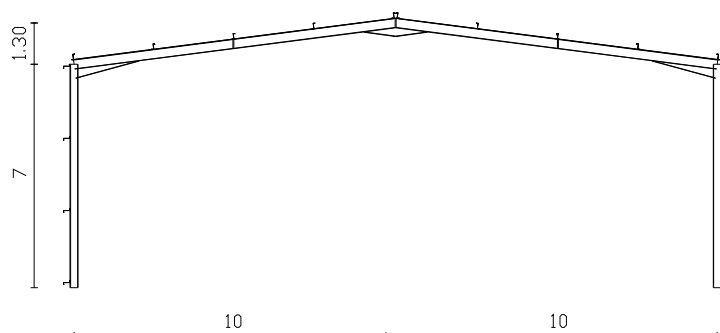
Pórtico rígido viga e pilar de alma cheia, vão de 20.00m com esquadros ligação pilar/viga, viga/viga
